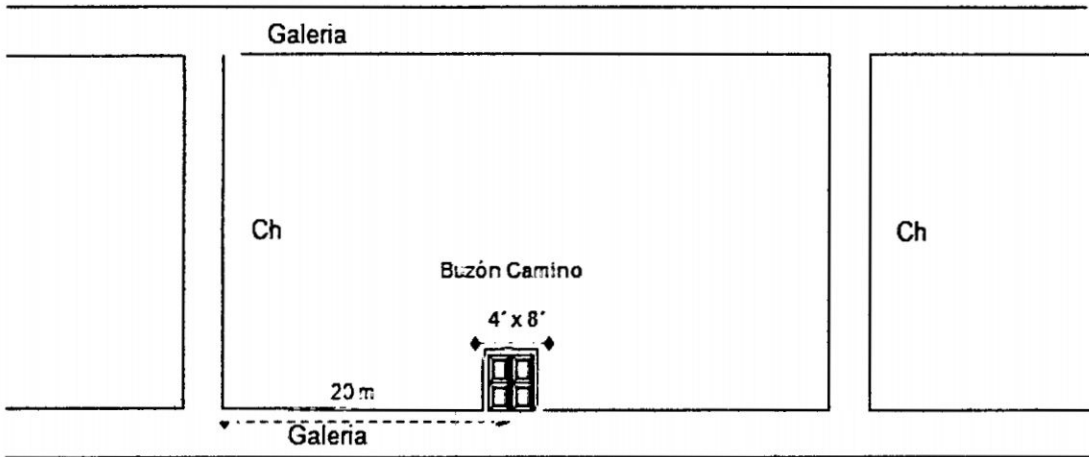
vista transversal de un block delimitado indicando buzón-camino
